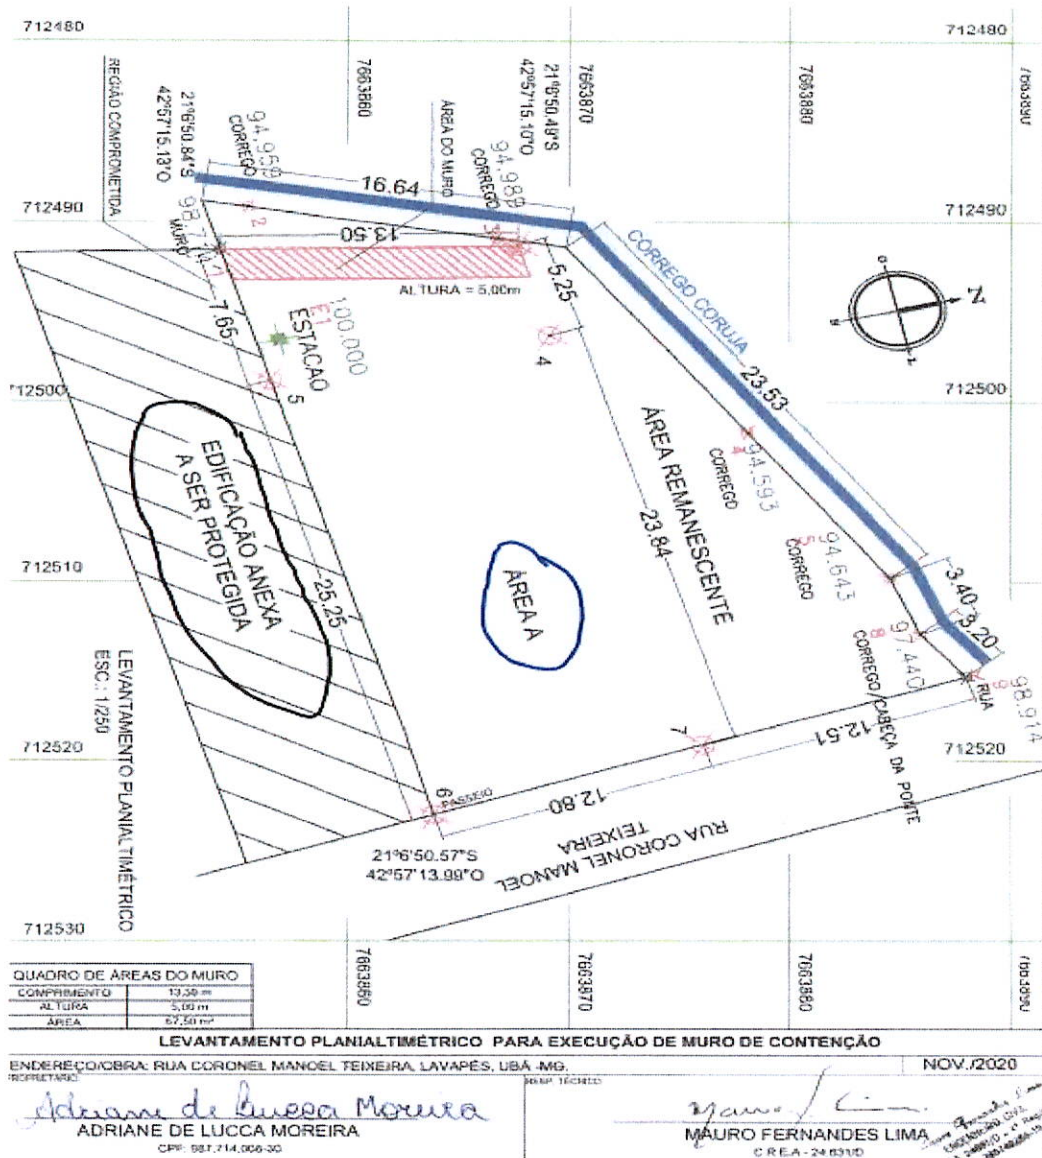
Recorte da imagem da planta planimétrica do local do muro em vermelho, a edificação anexa a ser protegida e a área A do imóvel, onde não demonstra a edificação já existente.
